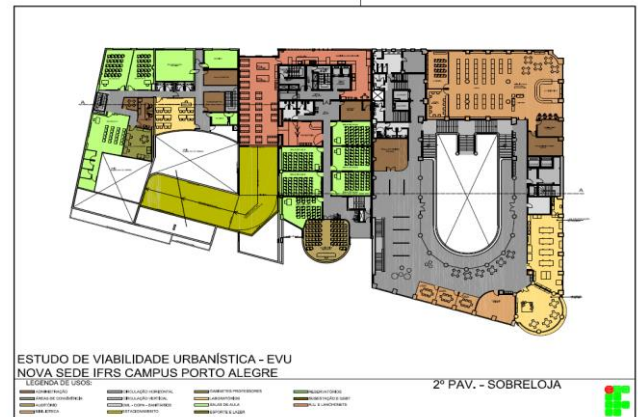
Planta baixa sobreloja - EVU- IFRS Poa
